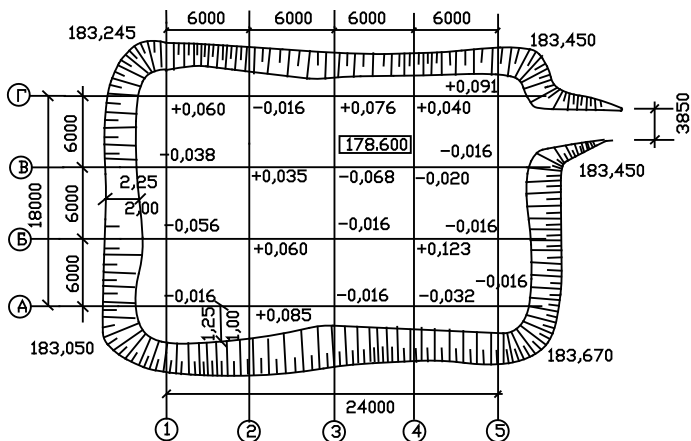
Схема исполнительной съемки котлована: 178,600 – проектная отметка дна котлована
